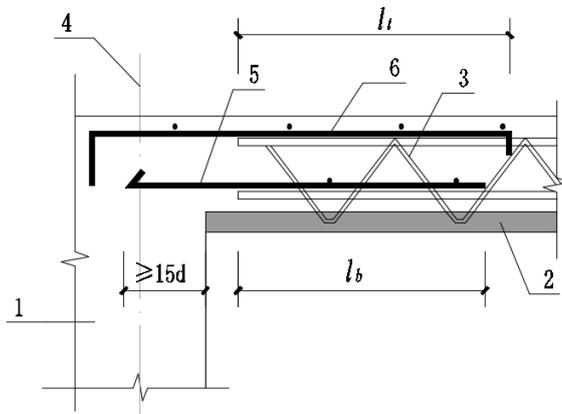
钢筋桁架保温混凝土板端节点支座构造示意
